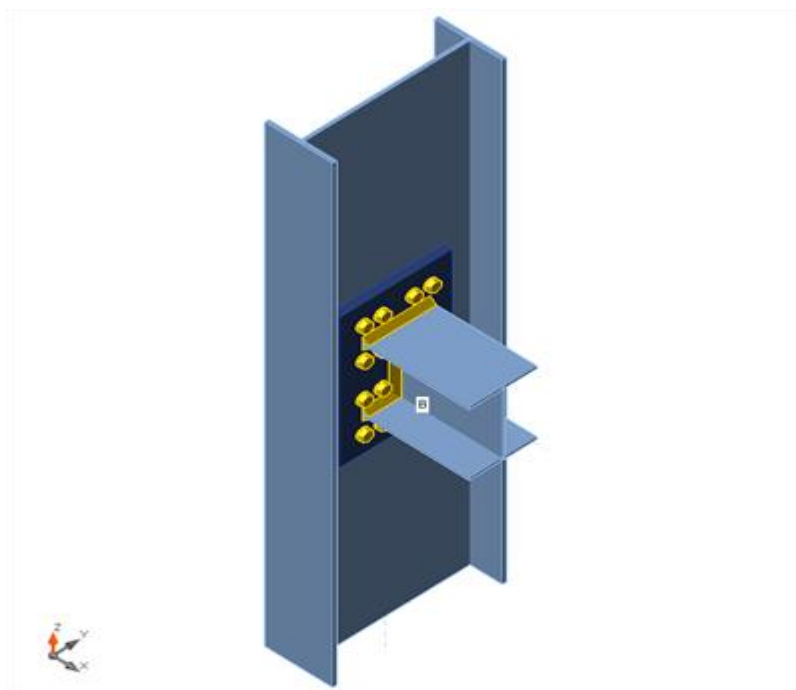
Vue d'assemblage poteau HEB280–Poutre IPE240
